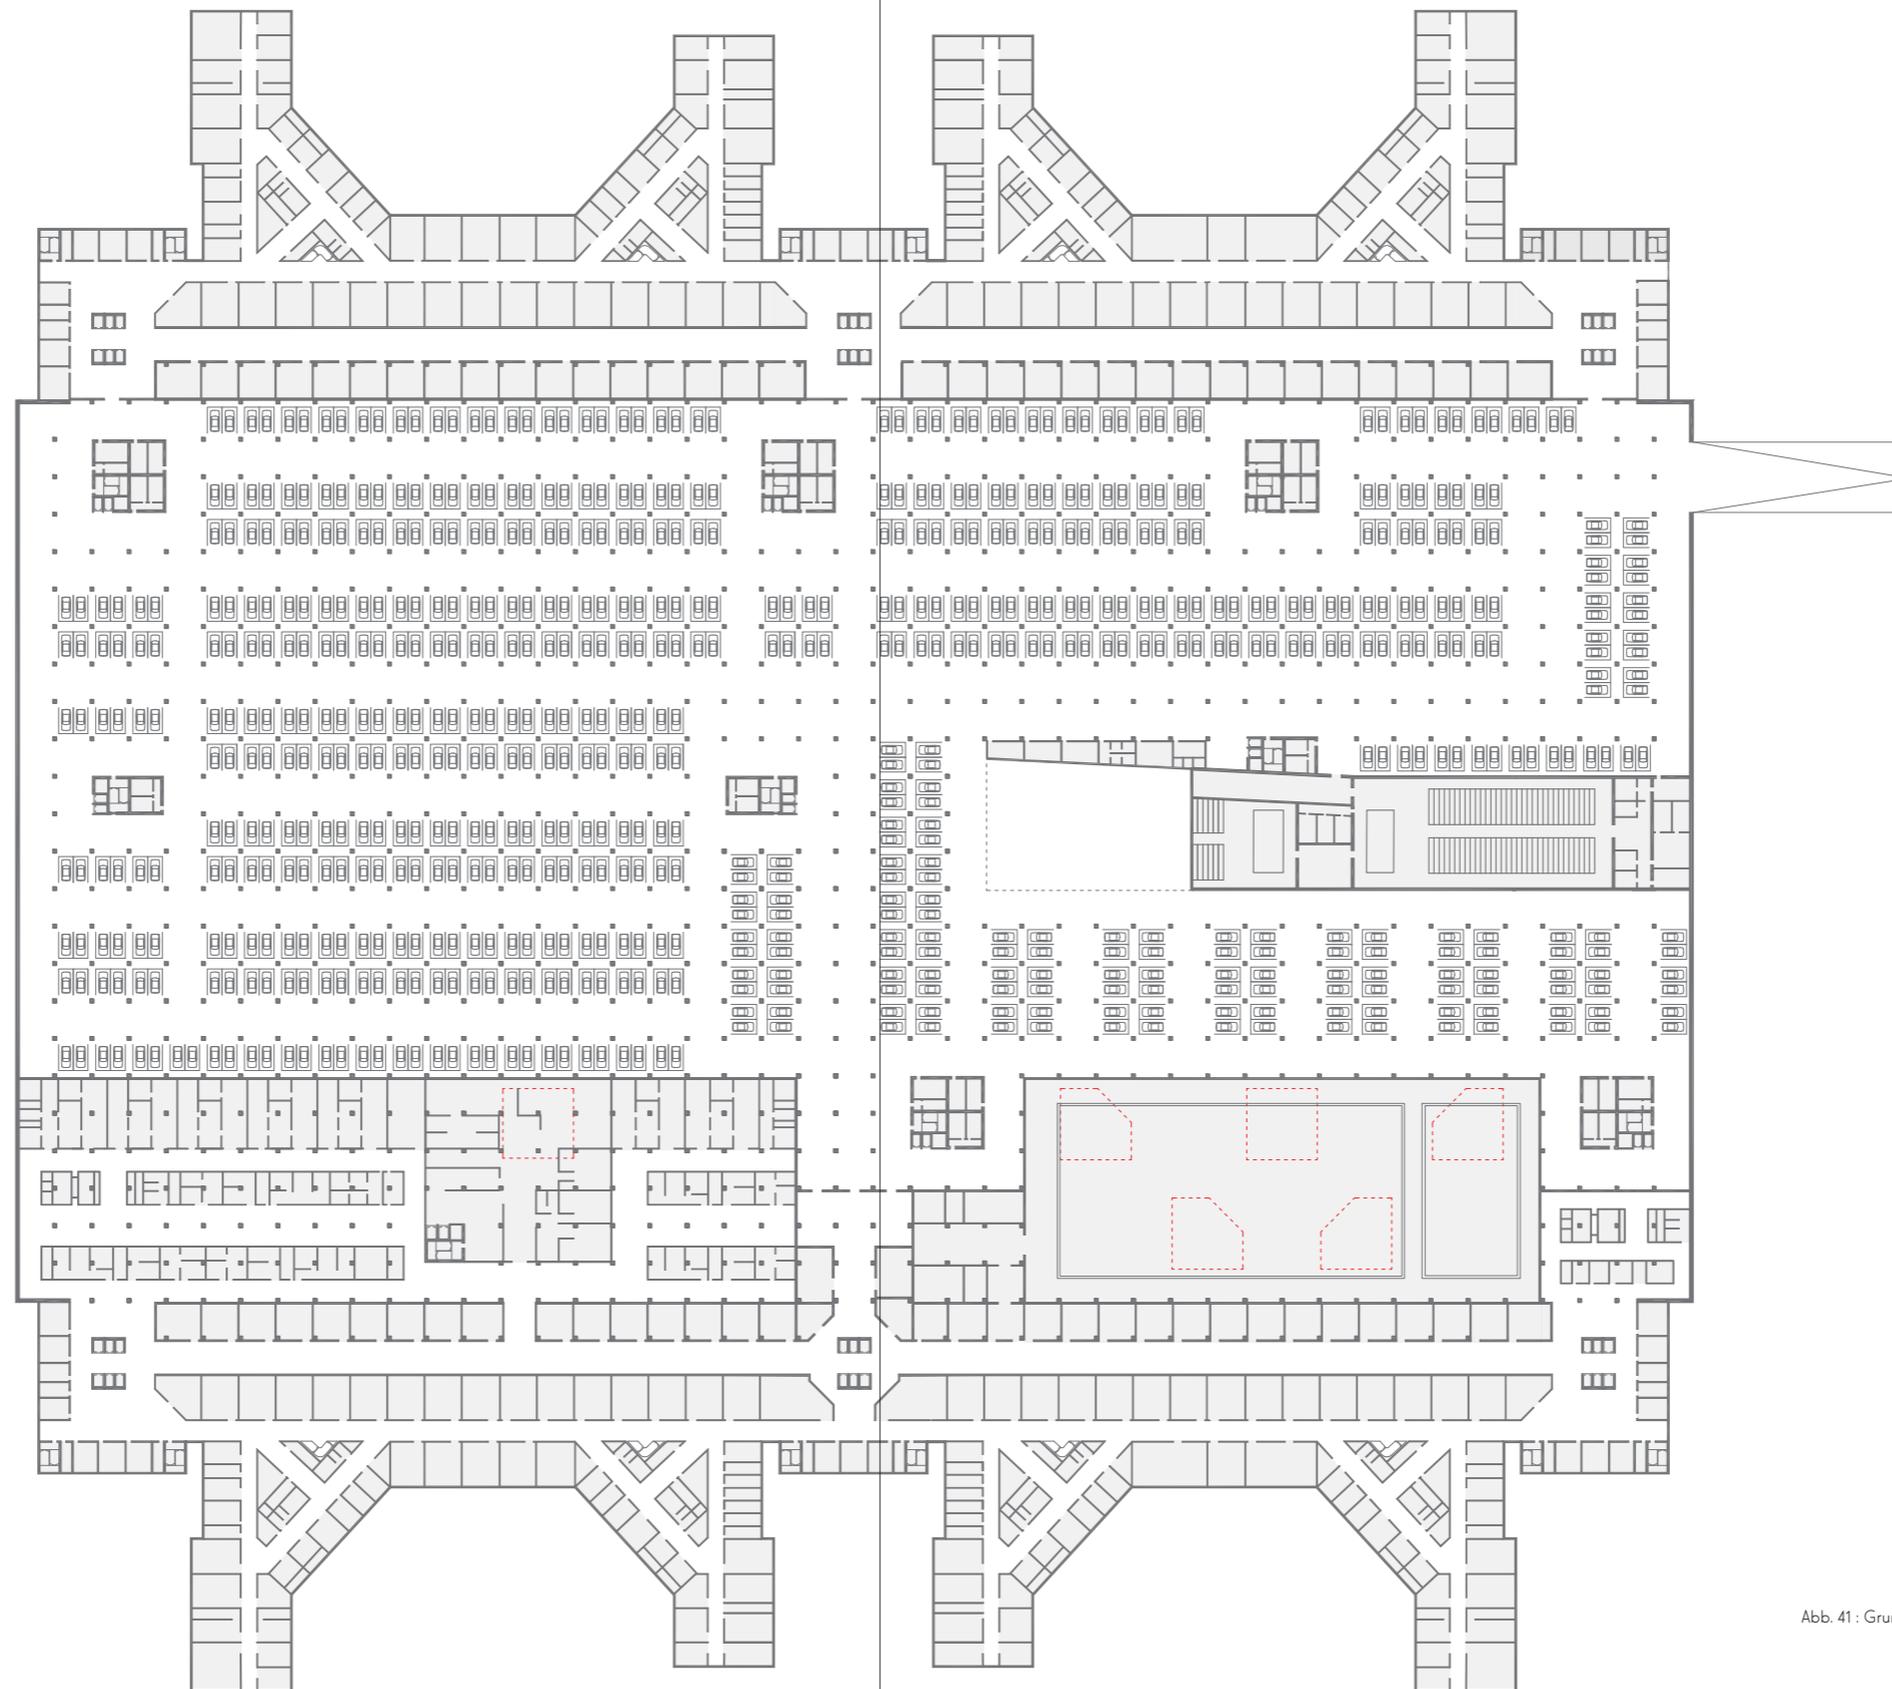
Grundriss Untergeschoss, M.1:1500
